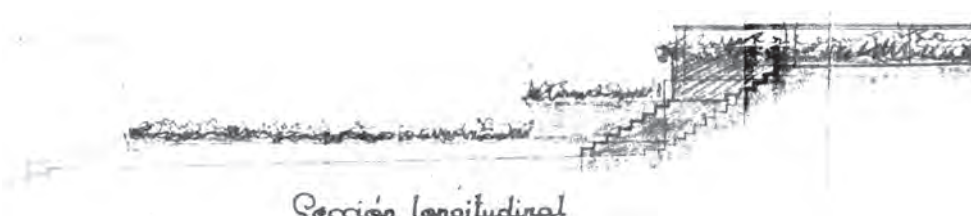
28. 1956. SECCIÓN LONGITUDINAL
